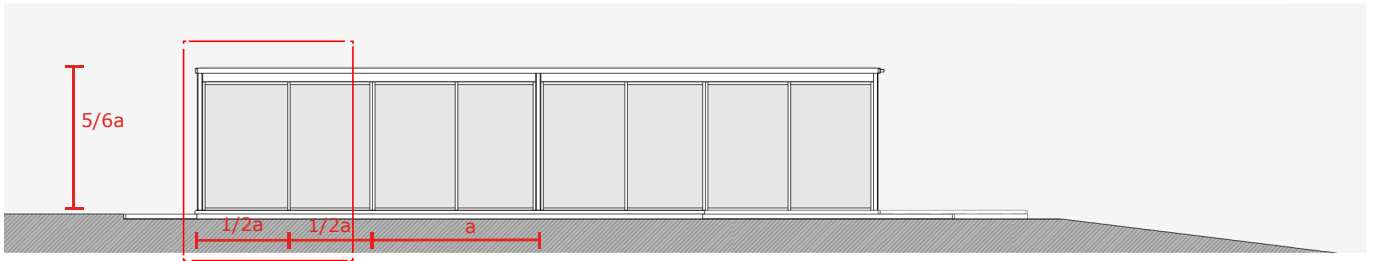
Vista de la fachada Norte y parte del garaje CSH #21
